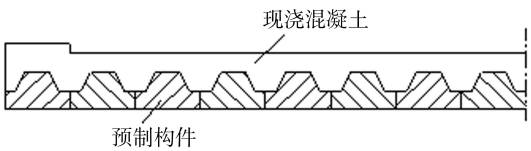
混凝土组合构件(预制-现浇混凝土组合板)
